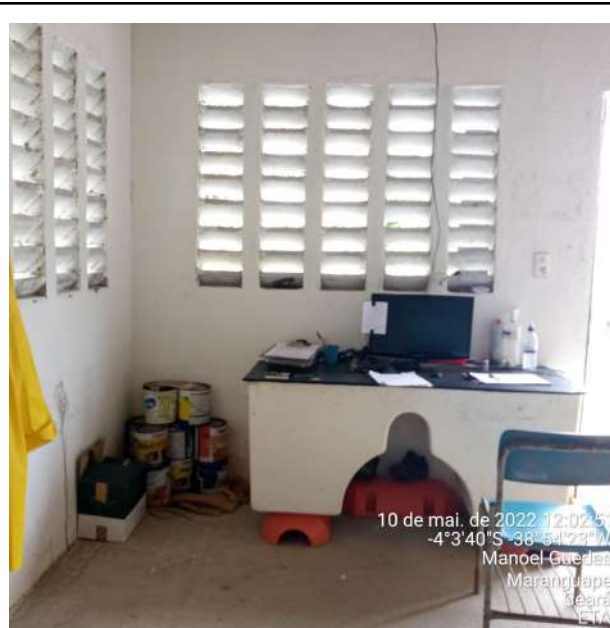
ETA: sala de apoio dos operadores com infraestrutura precária e armazenamento improvisado.
